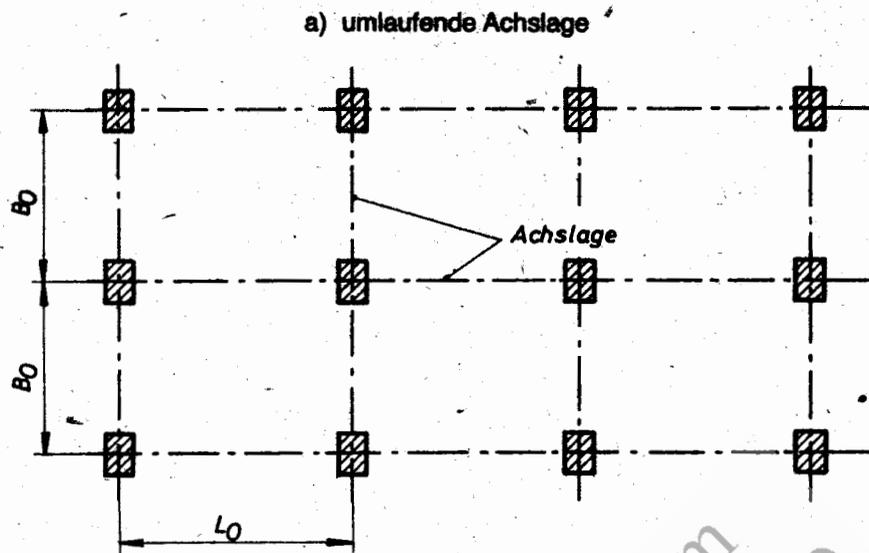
Zuordnung einer mehrgeschossigen Skelettkonstruktion zu den Systemlinien im Grundriß
